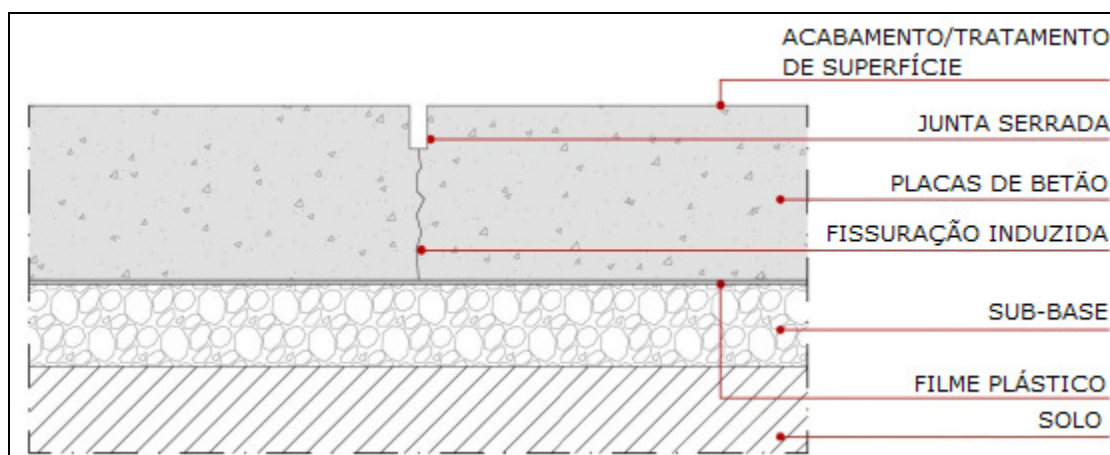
Corte: Pavimento industrial de betão simples (Cristelli, 2010).
